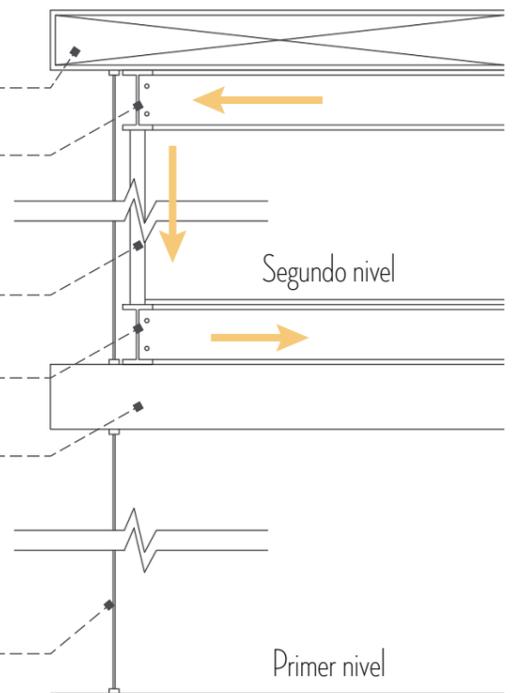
Detalle de encuentro en fachada con 2 niveles.
